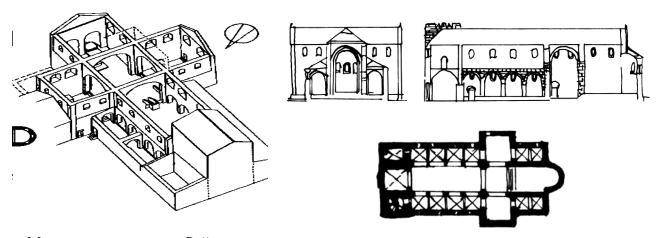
Оттмарсхайм. Церковь (1030–1049). Фасад. План. Разрез
